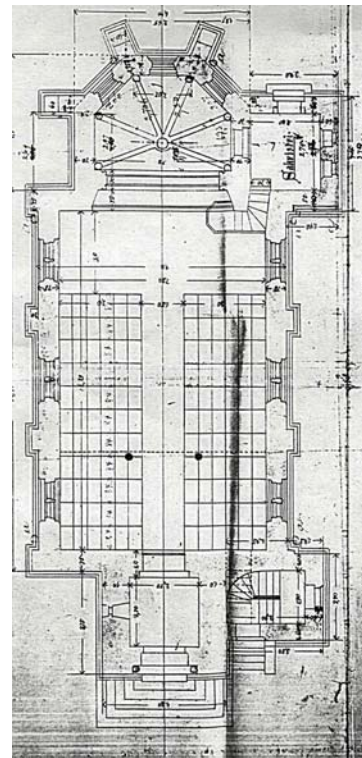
Grundriss Erdgeschoss, Baupläne März 1892
